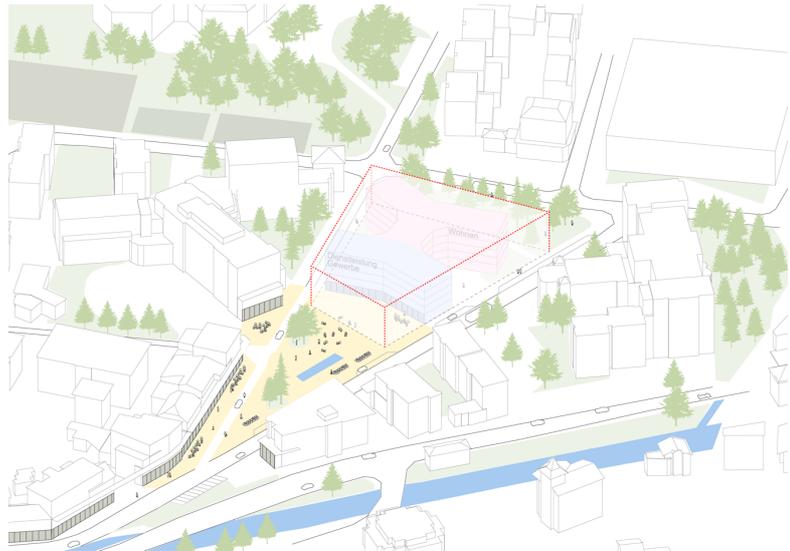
Piazza Rosatsch mit Hoch- und Tiefbauten
